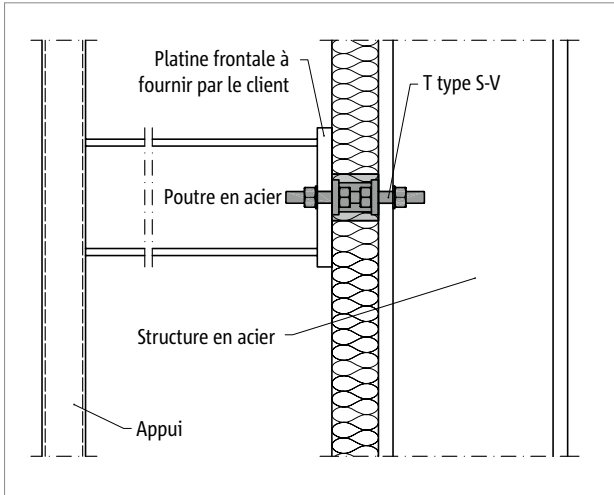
Schöck Isokorb® T type S-V : structure en acier sur appuis
